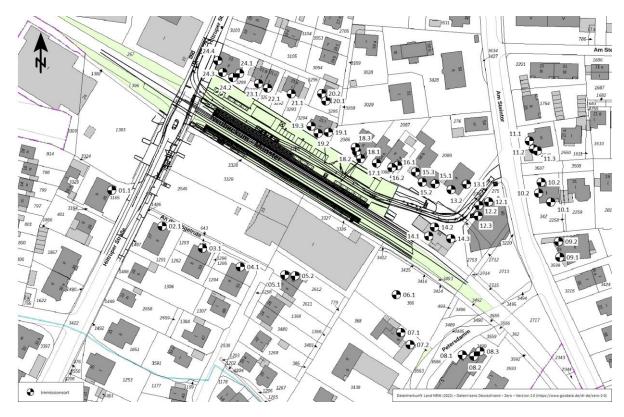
Übersichtslageplan mit Darstellung der betrachteten Immissionsorte
